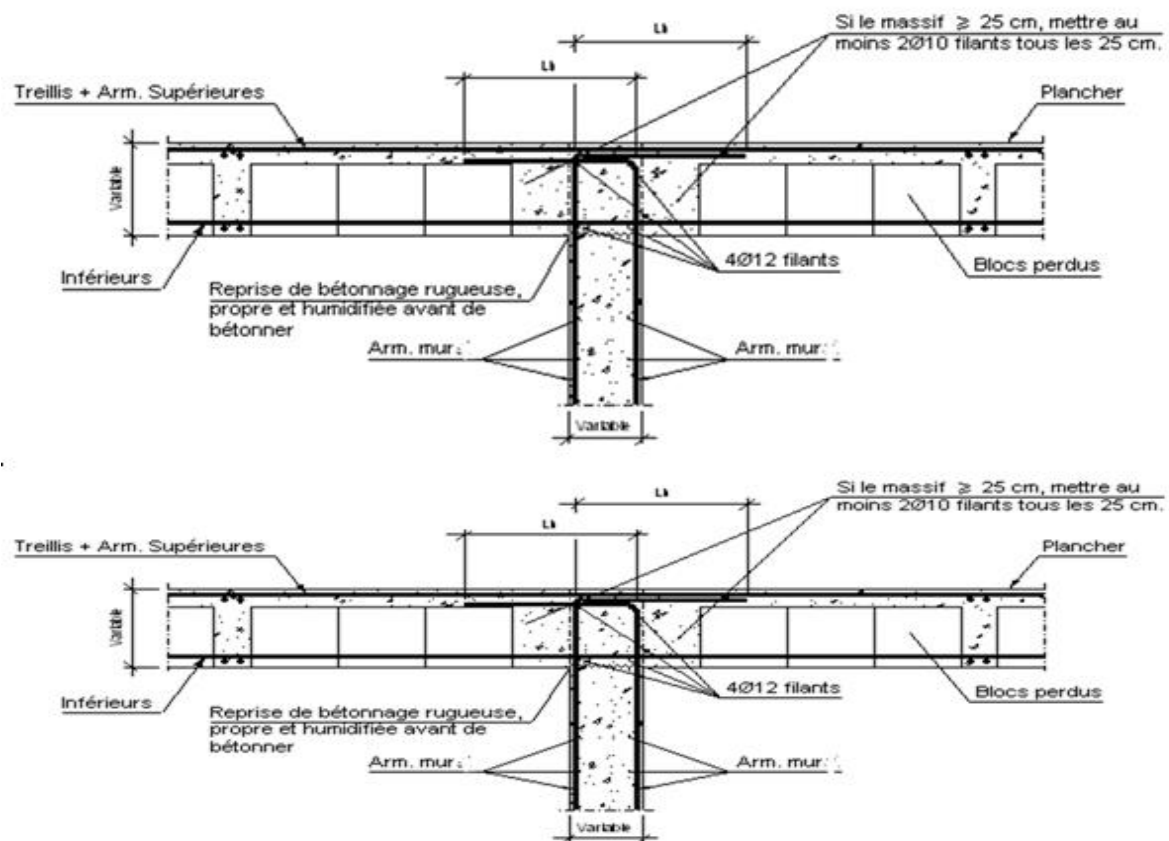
Schéma illustratif des détails constructifs de l'appui du plancher réticulé sur voile
